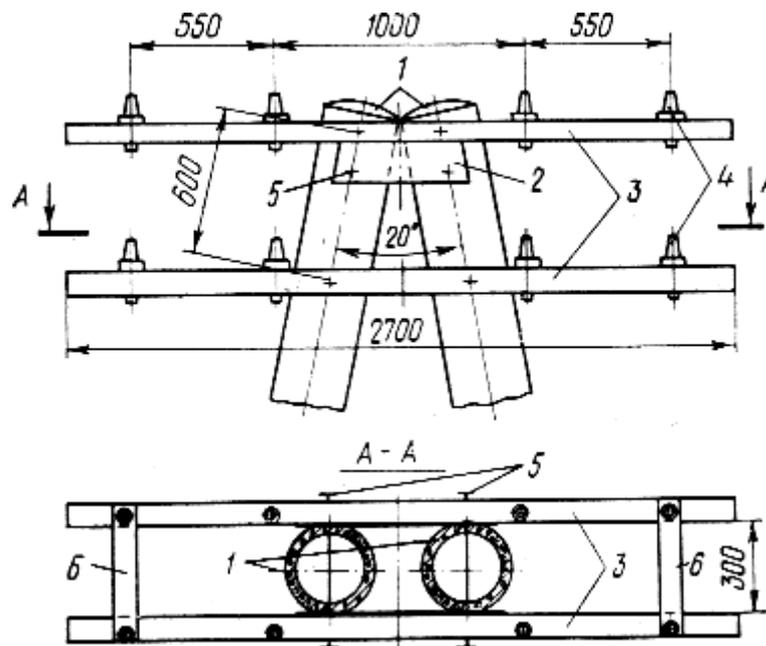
Верхушка. А- образной угловой железобетонной опоры ВЛ до 1 кВ:
